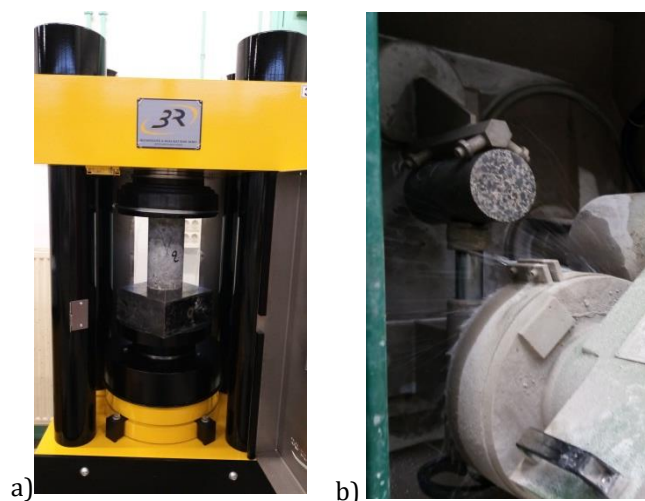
(a) Presse et (b) surfacage des éprouvettes pour essai de compression simple.
